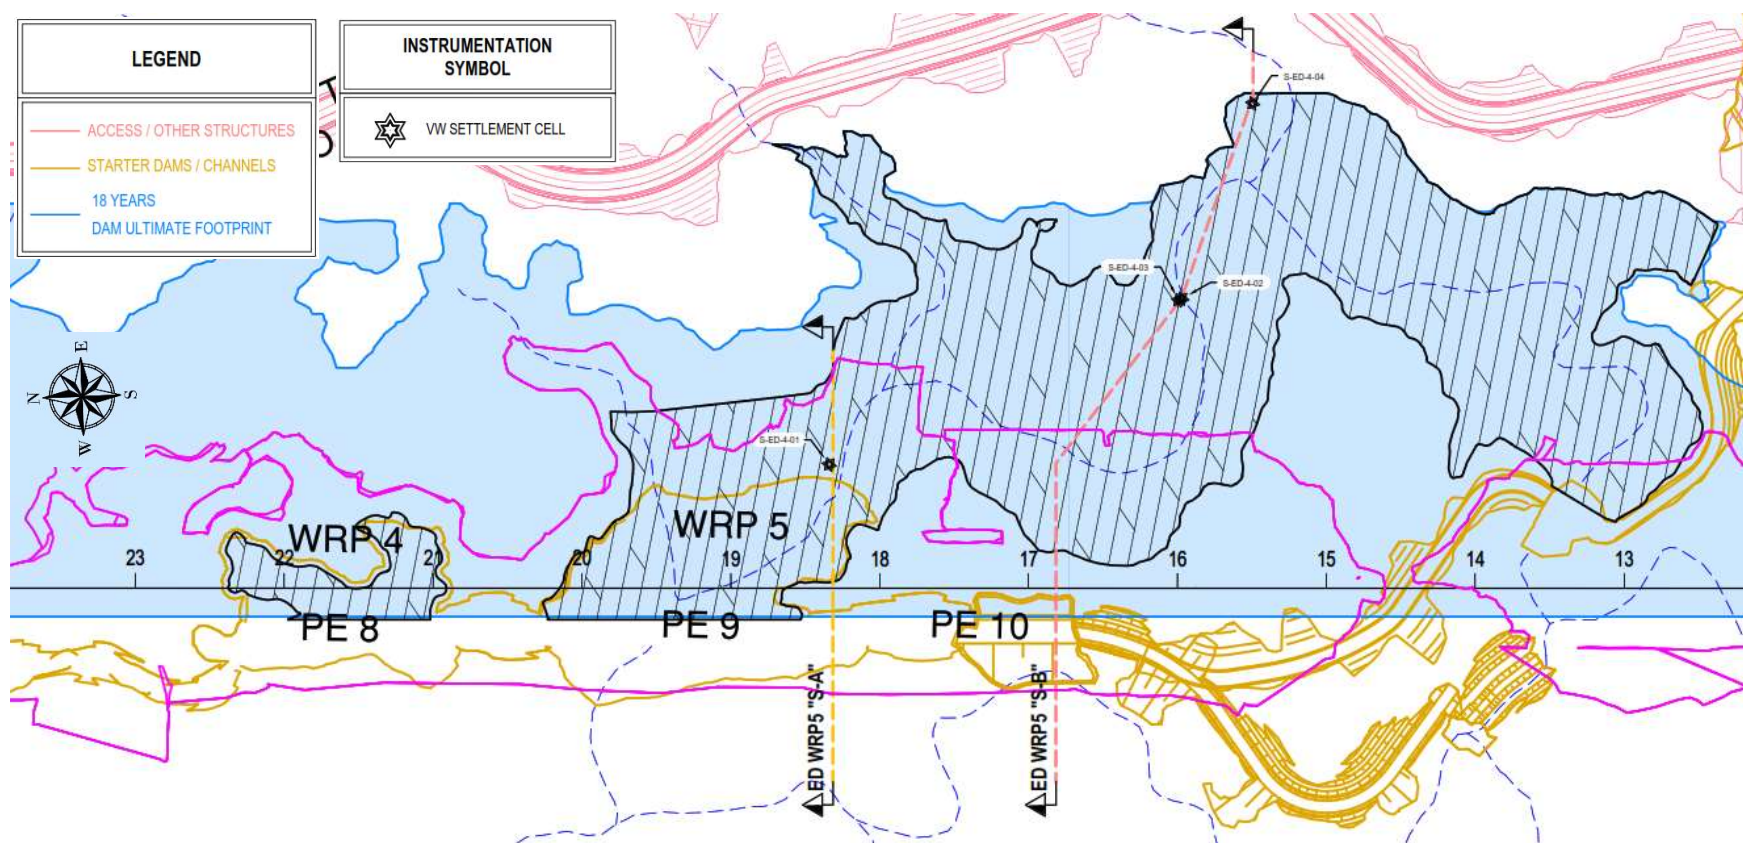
1: Vista en planta de la PE WRP5 – Grupos de instrumentos de celdas de asentamiento
